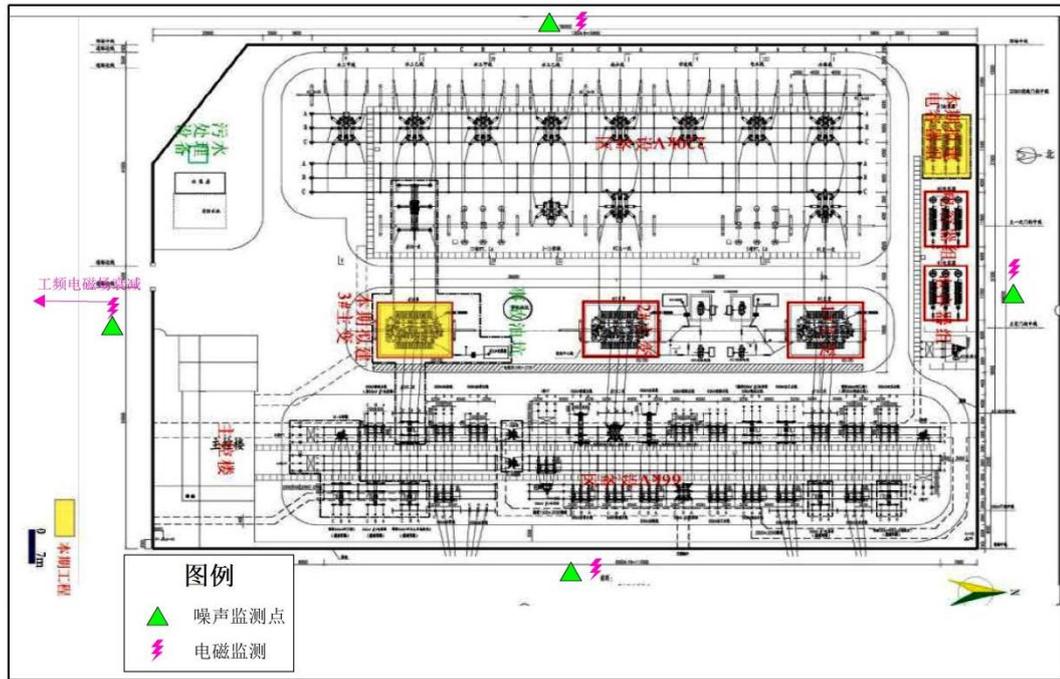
220kV 类比站总平面布置及监测点布置图
